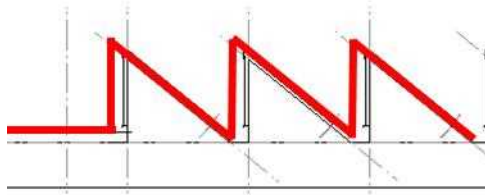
Variante (a) Erhalt der Sheddach-Elemente
